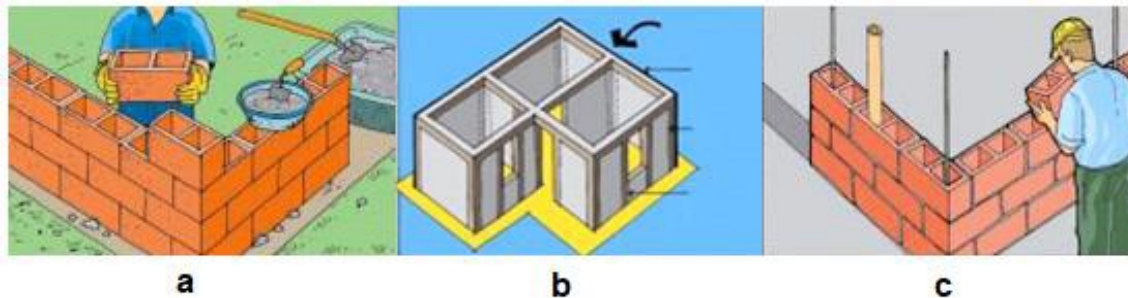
Clasificación de Tipos de Viviendas. (a) mampostería no reforzada. (b) mampostería confinada. (c) mampostería reforzada.
